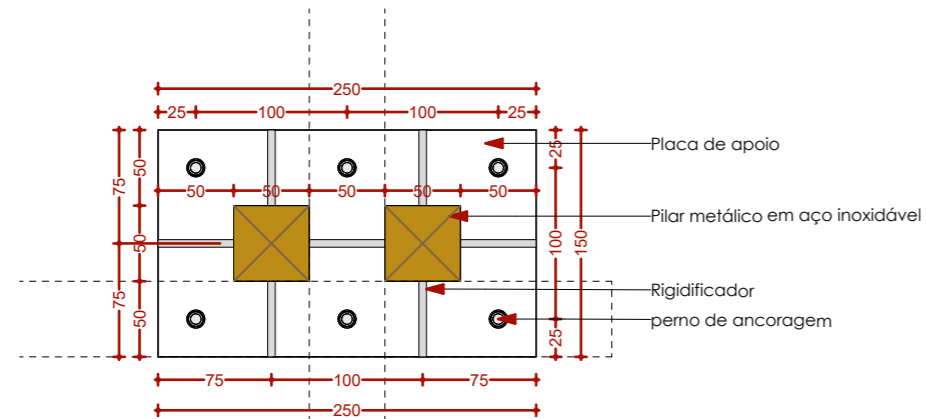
DETALHE DA FUNDAÇÃO DO PERGULADO
